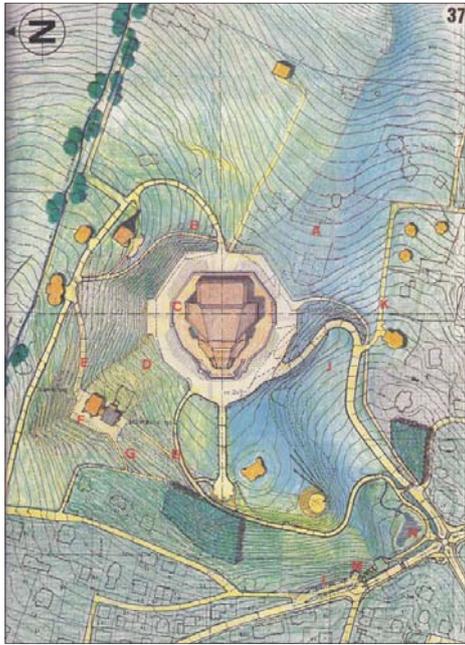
Rudolf Steiner - Planimetria della collina di Dornach, Secondo Goetheanum ed edifici minori. Dornach, Svizzera.
